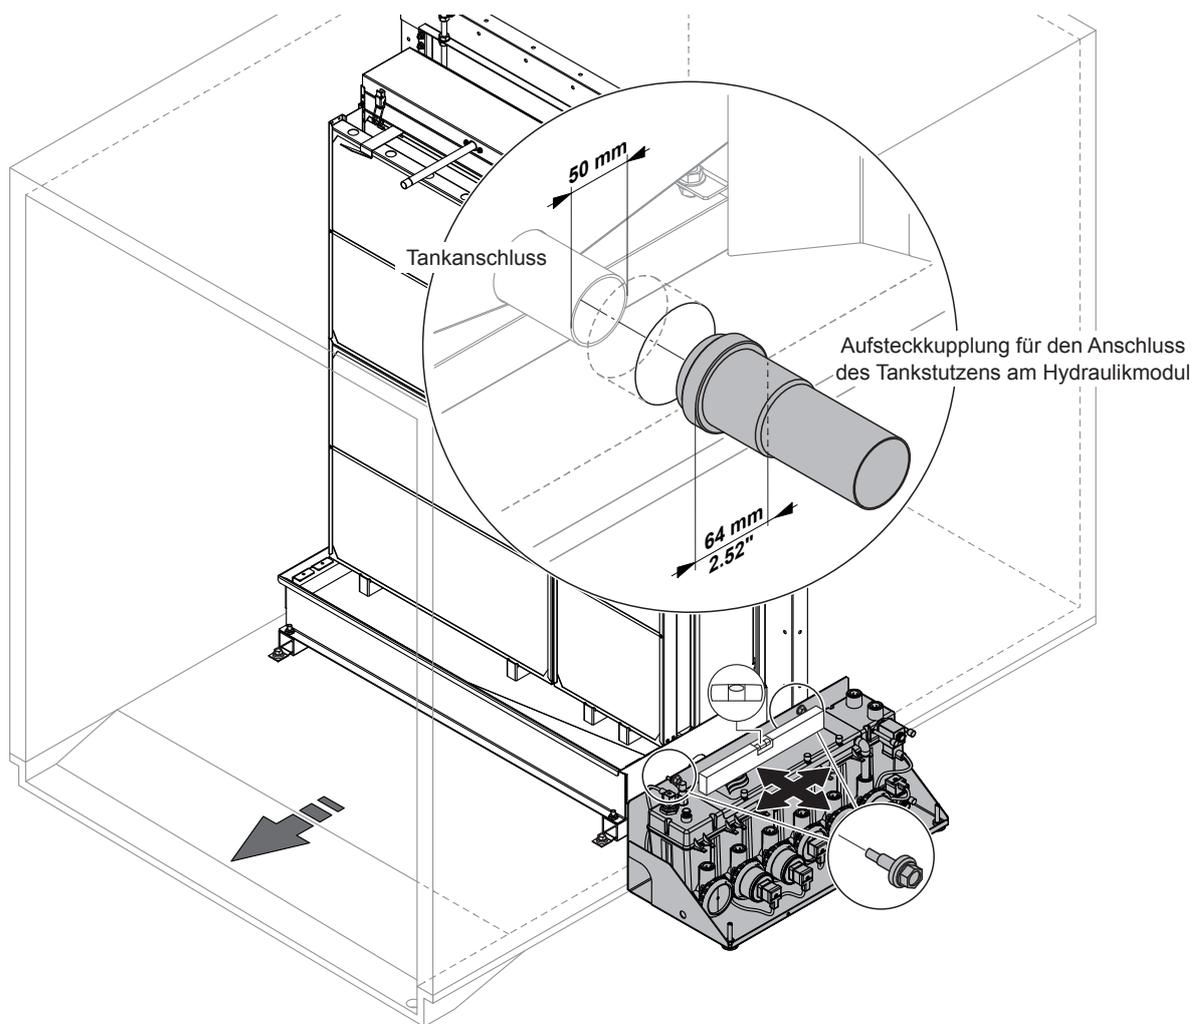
Hydraulikmodul montieren, Aussenmontage, Wassertank mit Seitenablauf
